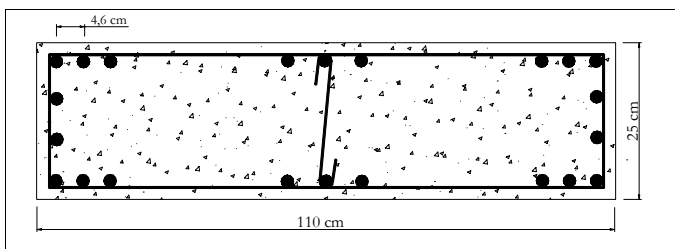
Caso 3: Arranjo das armaduras na seção transversal do pilar P1.
